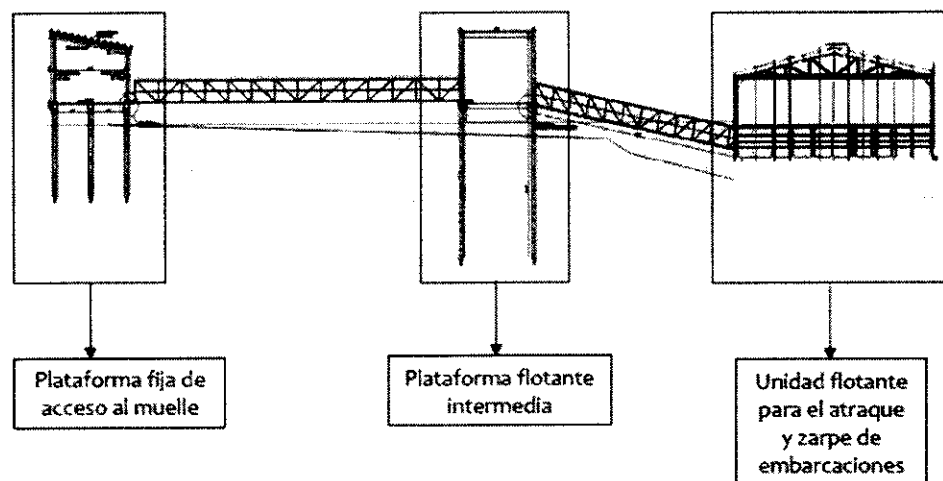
Perfil Longitudinal muelle proyectado para Istmina.
